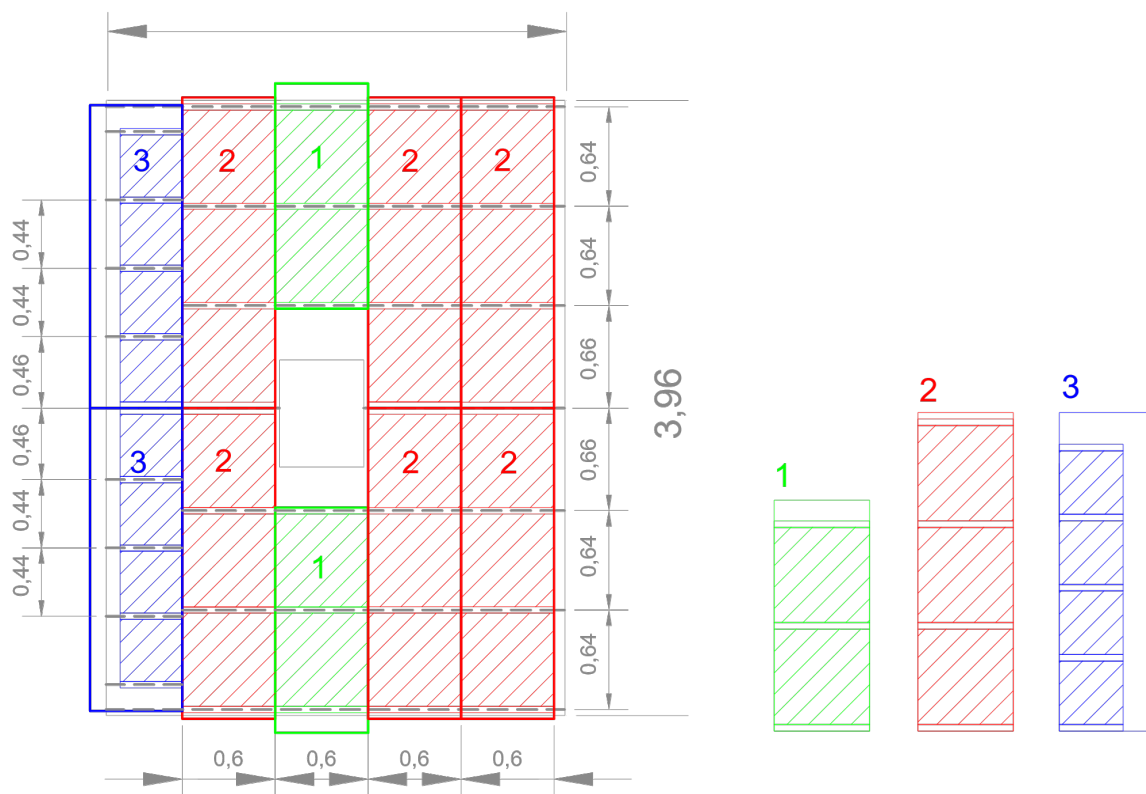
Esquema da aplicação dos painéis VIP na solução de isolamento pelo interior em Coimbra.
